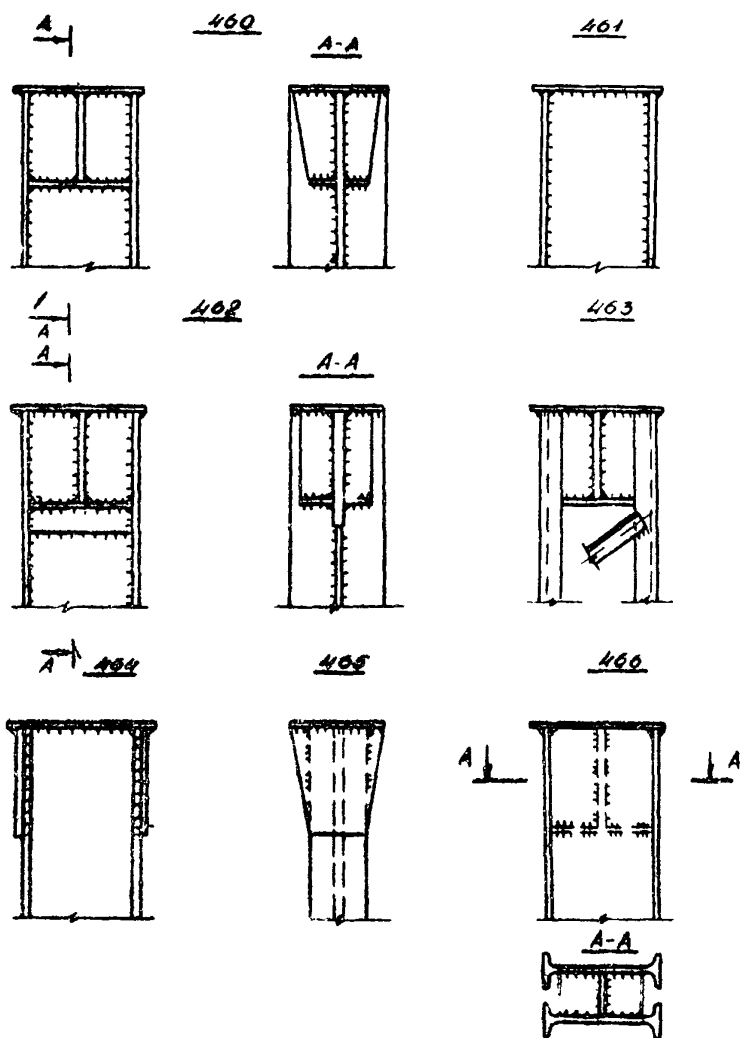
Оголовки колонн при опирании на них конструкции сверху с кодами 460-466
